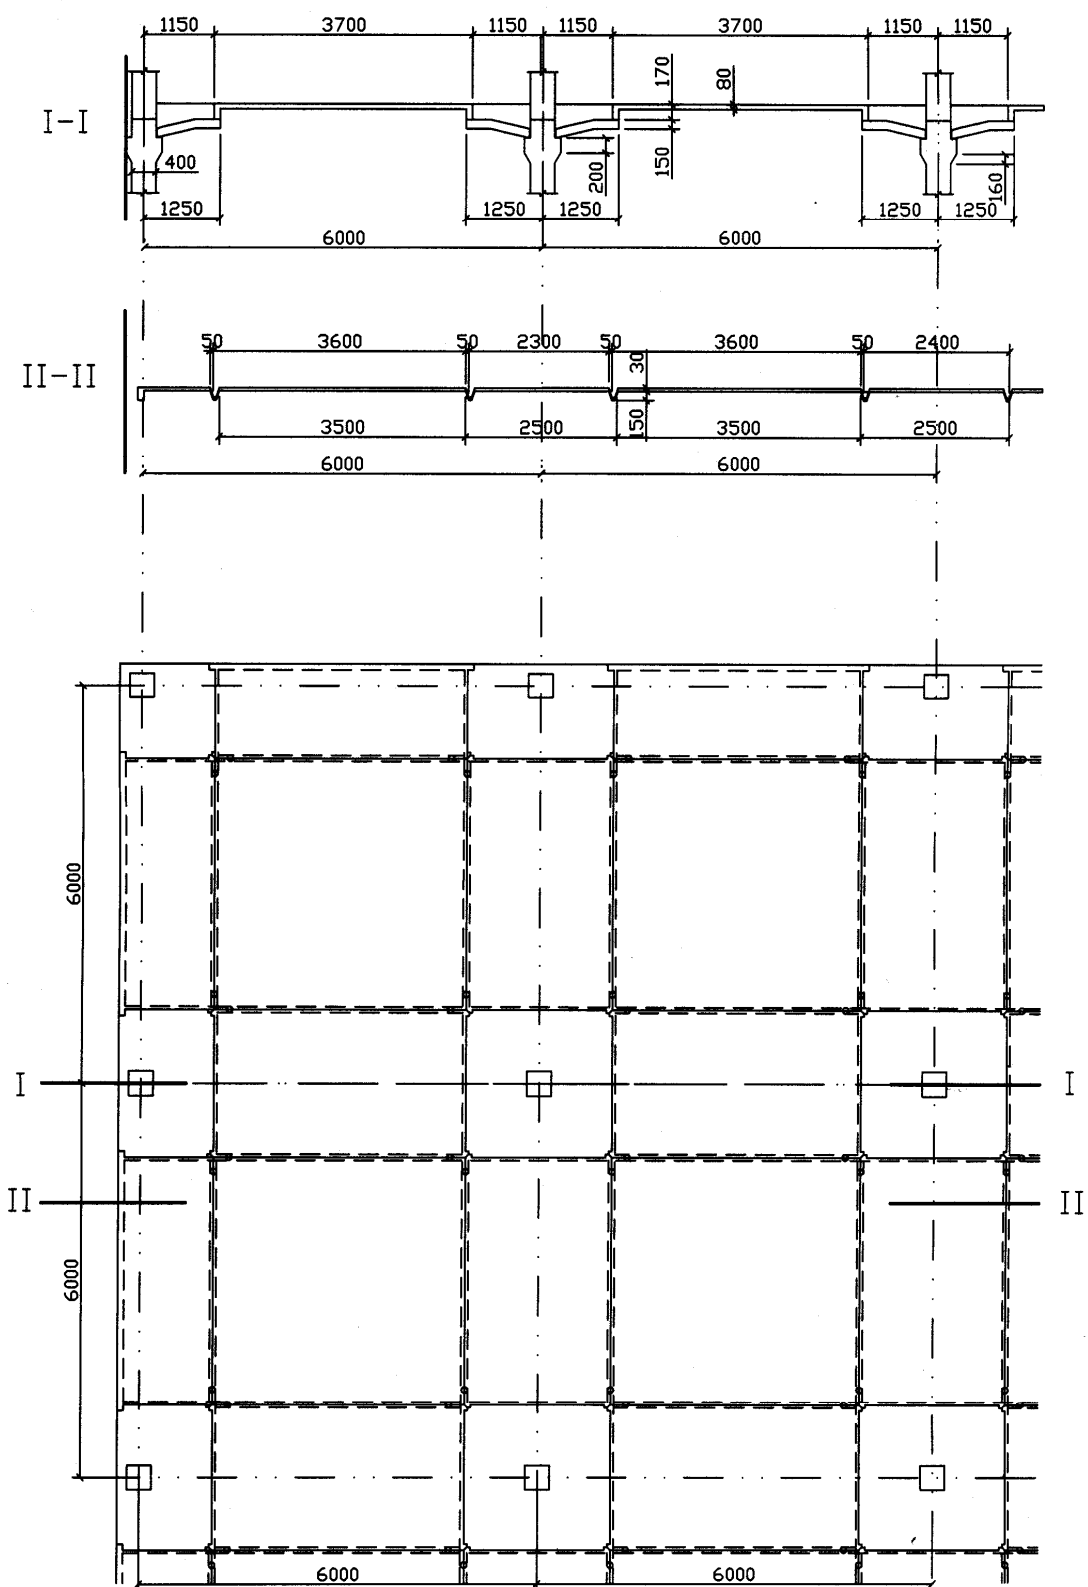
Схема збірного безбалочного залізобетонного перекриття
